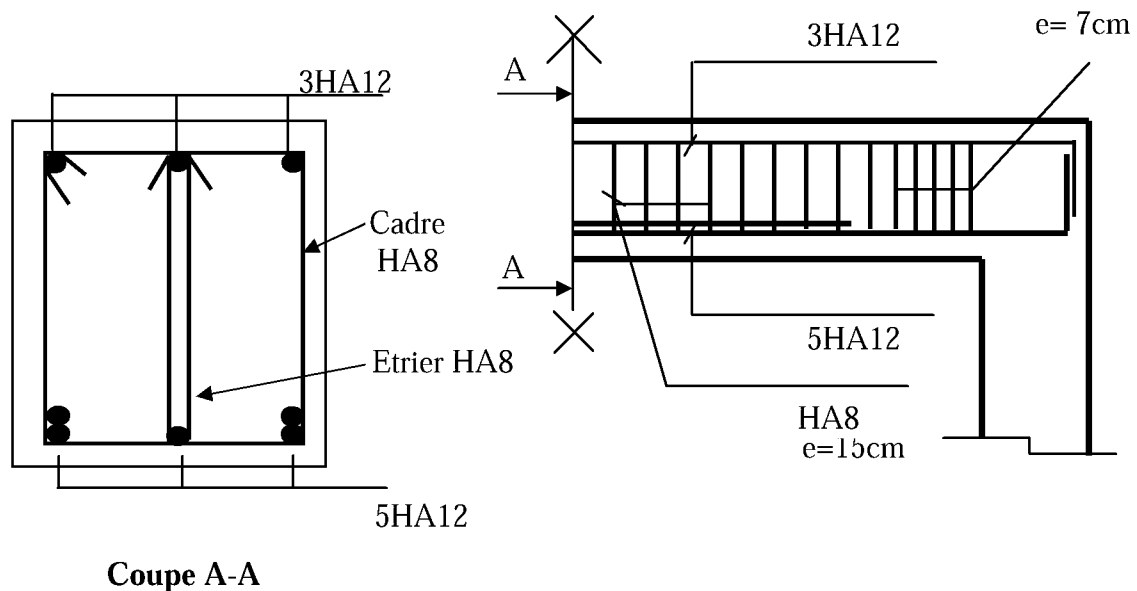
Schéma de ferrailage de la poutre palière.
